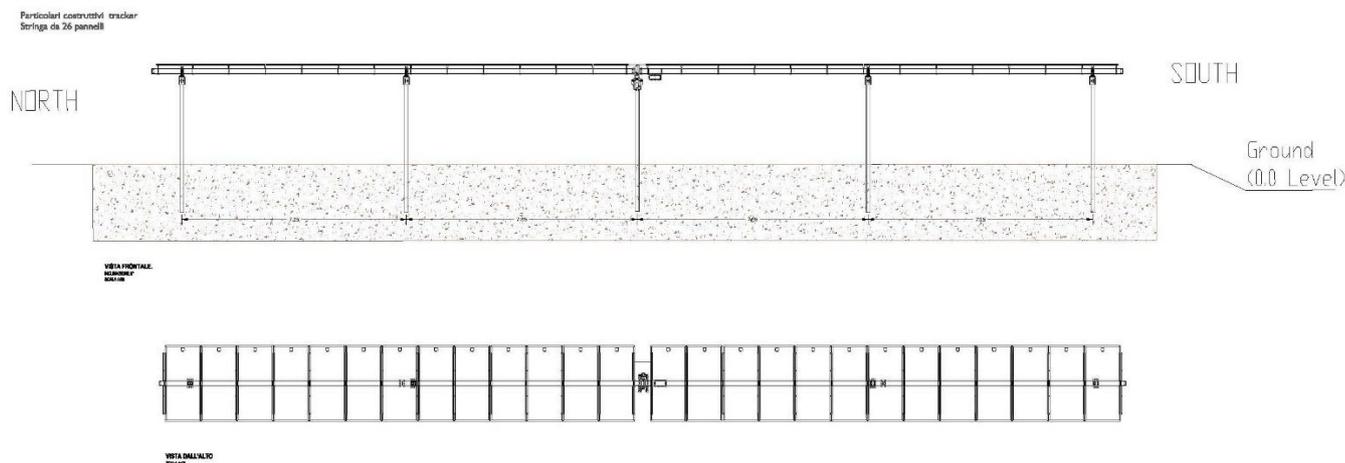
Vista laterale e vista dall'alto della singola stringa da 26 moduli
